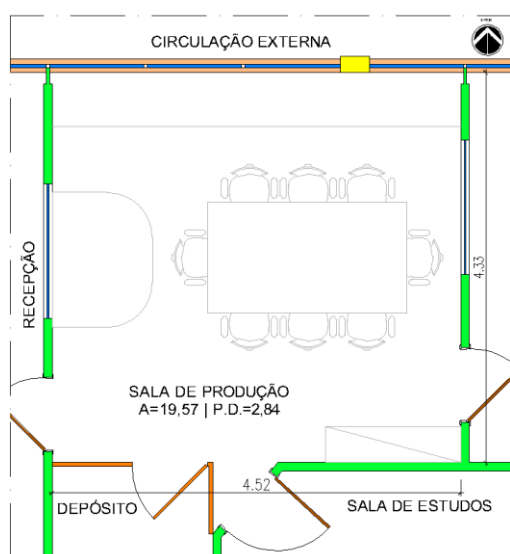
Planta baixa da sala com as dimensões e o layout.
